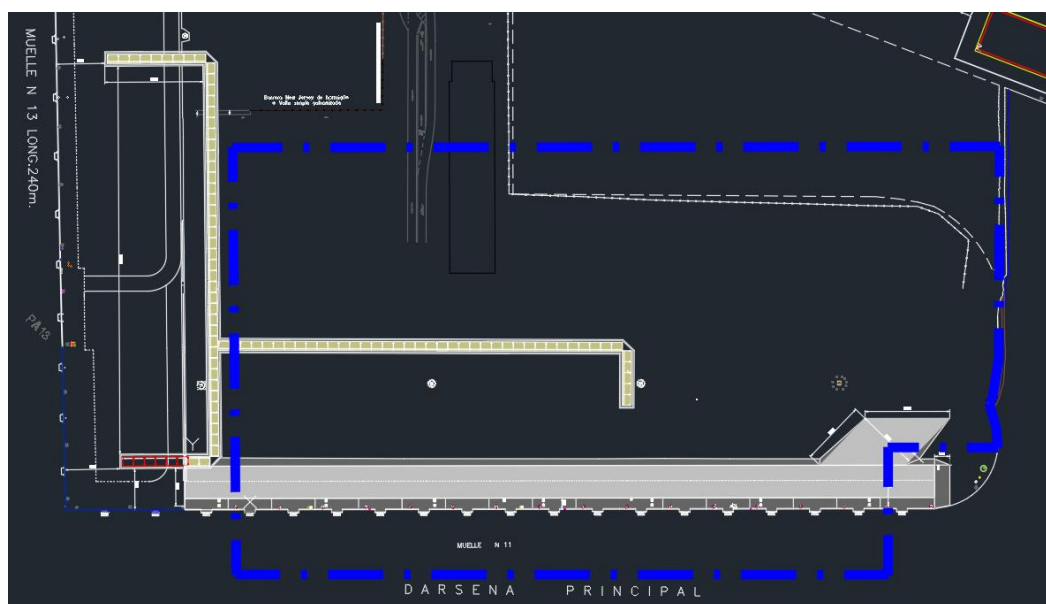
Trazado en planta sin intervenir del Muelle 11.
